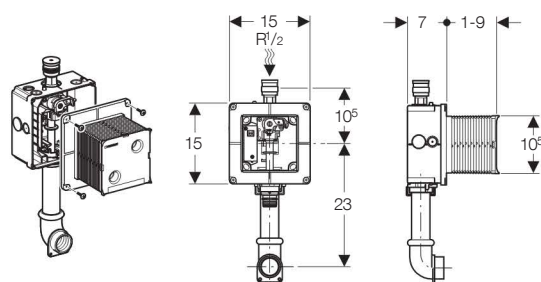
Abmessungen Geberit Rohbauset (Art.-Nr. 116.002.00.1)
